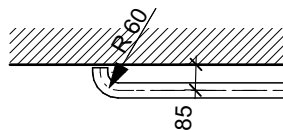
DETAIL KOTVENÍ SLOUPKU ZBOKU, M 1:10
